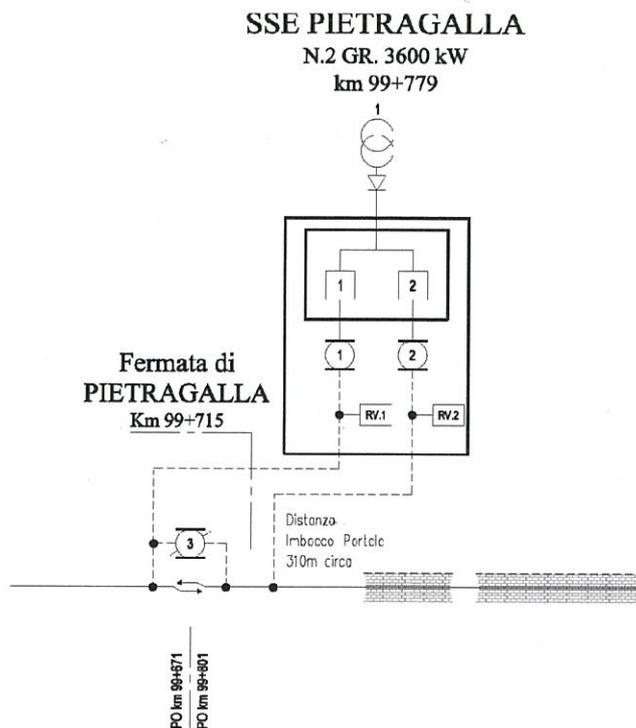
Stralcio schema TE – SSE di Pietragalla
